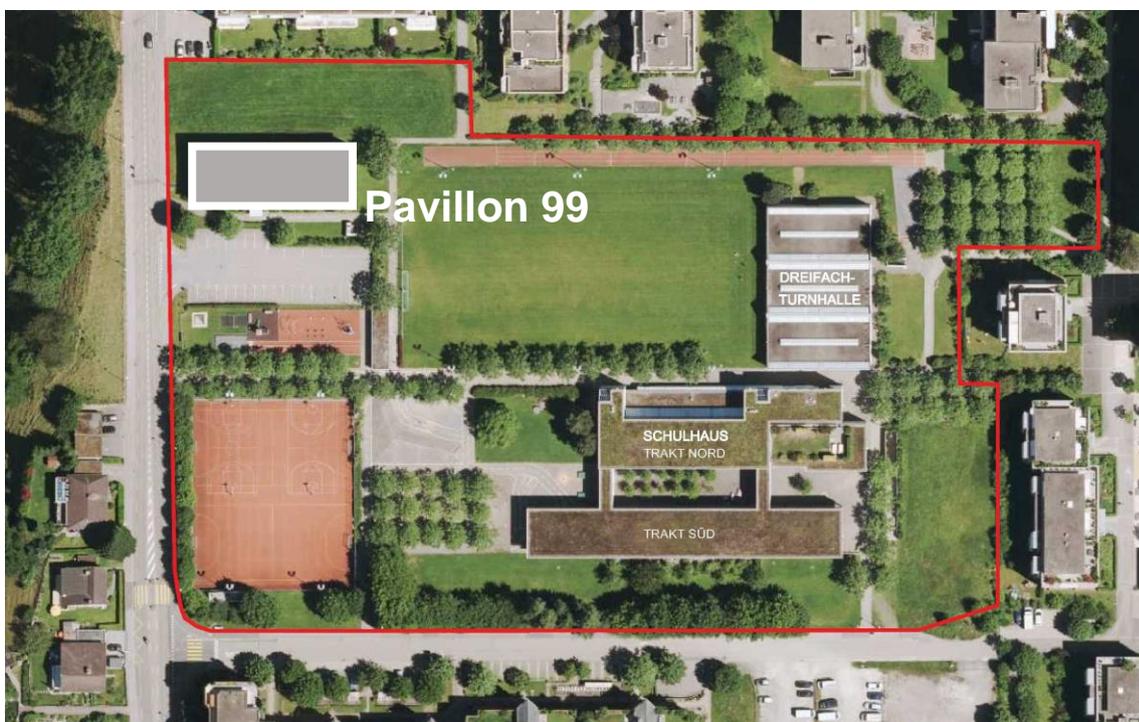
Situationsplan Schulanlage Ruopigen mit Pavillon 99
